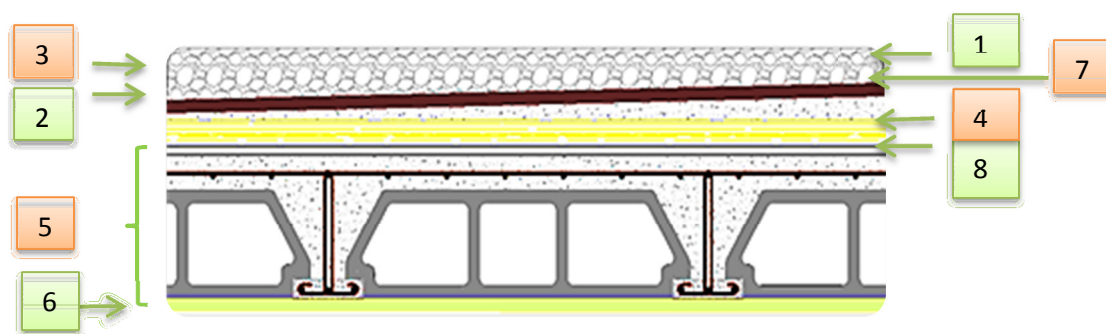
Composants d'un plancher terrasse en corps creux.
